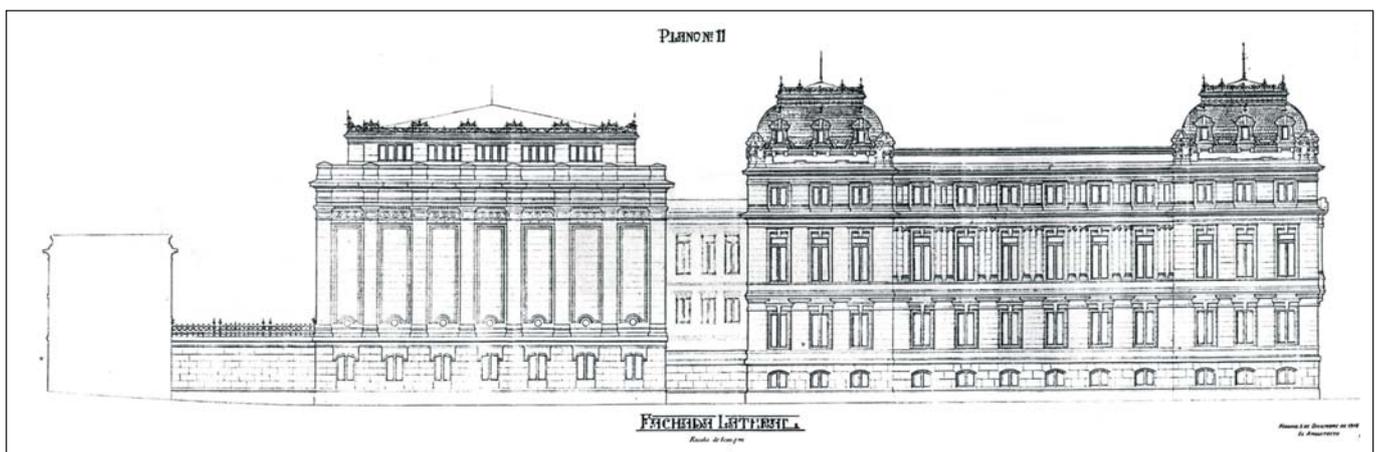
Fachada lateral del proyecto de Francisco Javier de Luque, 1918 (AH.IGME).
